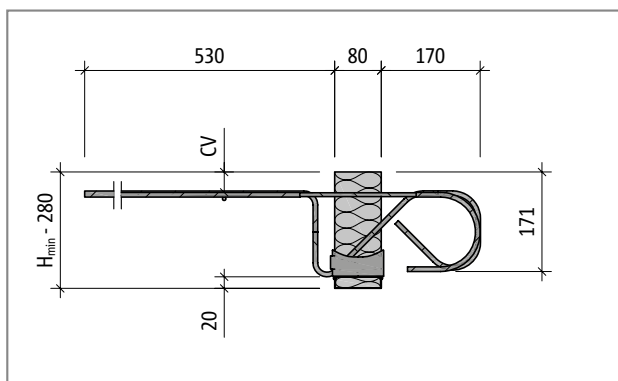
Schöck Isokorb® tipo K10S-UZ – K60S-UZ: Sezione dell'elemento
